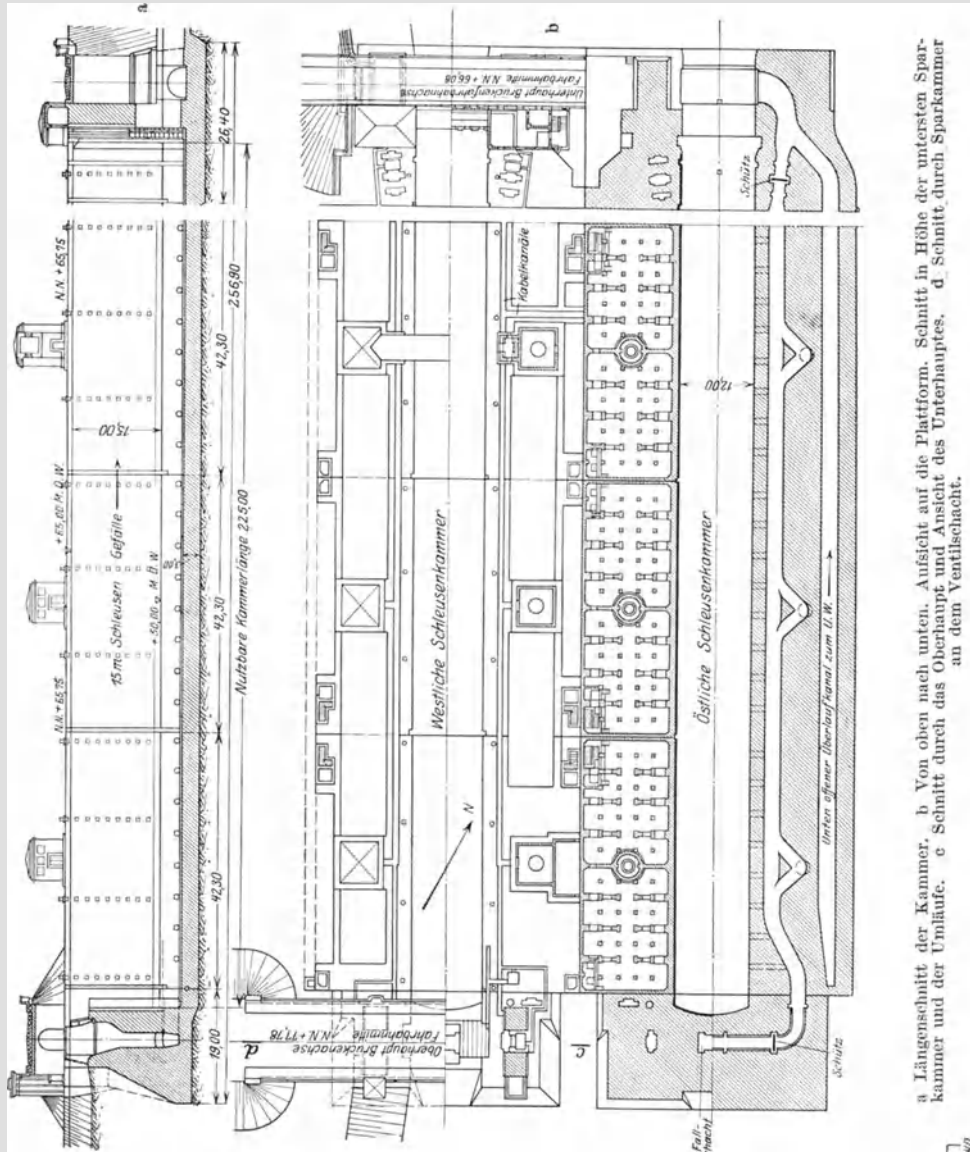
a u. b. Schleusenentwurf Hansa-Kanal für eine Sparschleuse (Plate).
